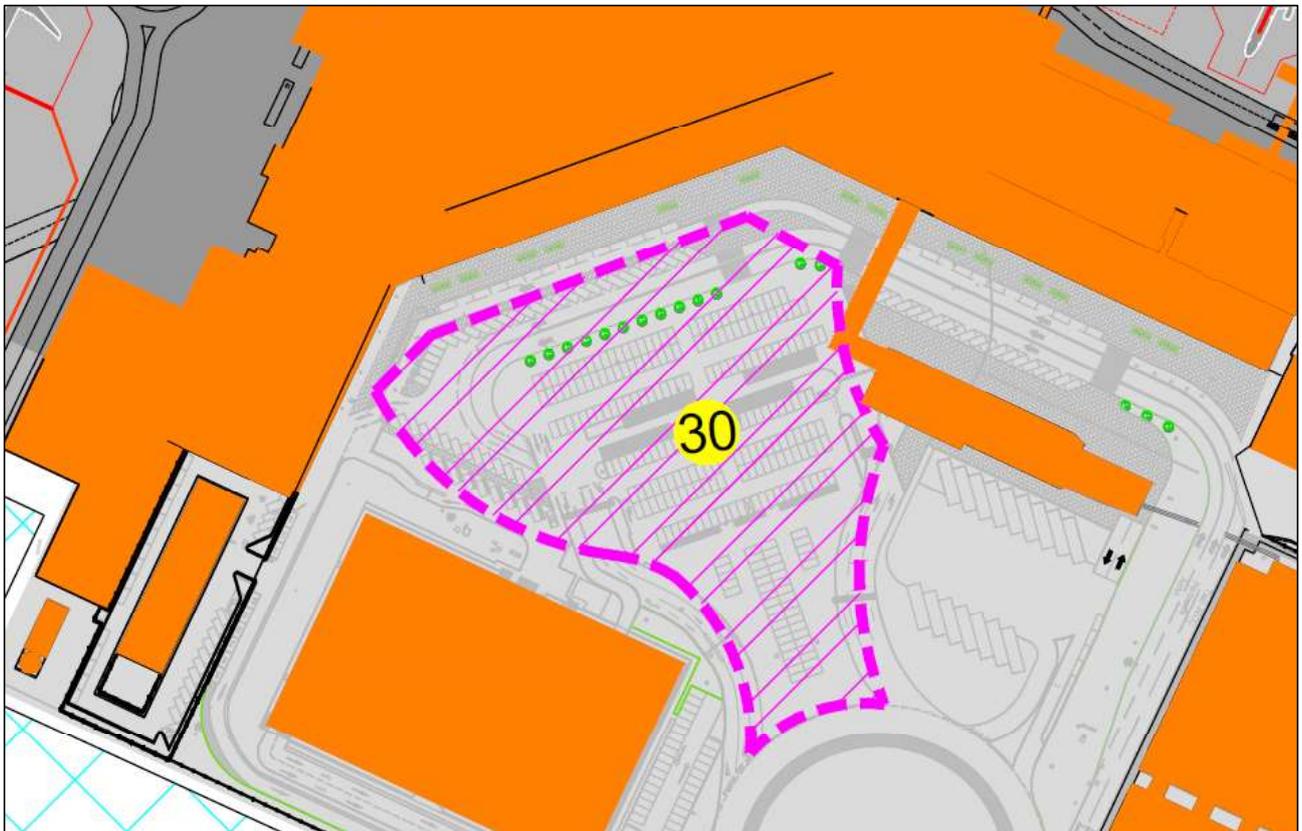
Estratto Master Plan – Riqualifica del Parcheggio P1
